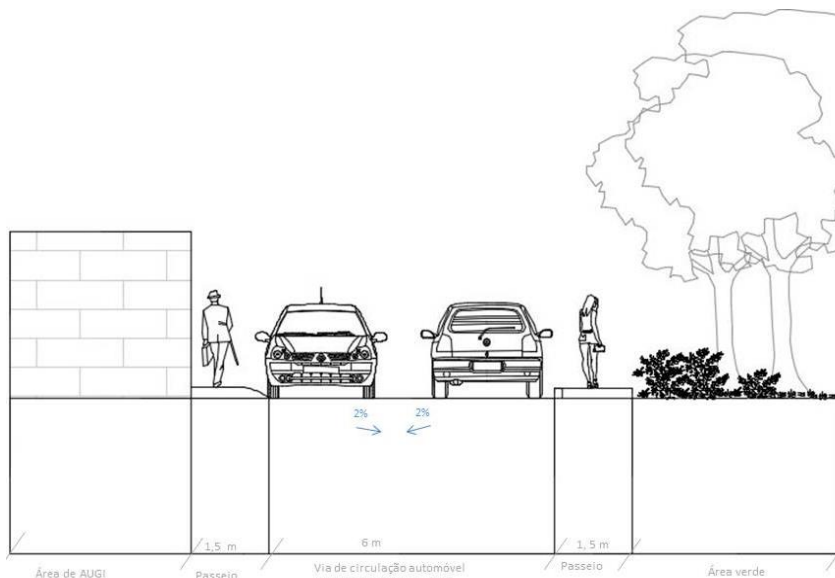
Perfil com a situação proposta - Travessa de Antevila
